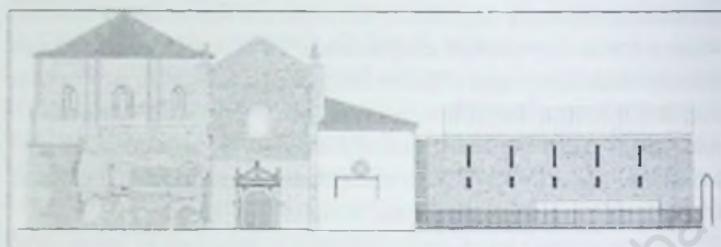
Proyecto. Alzado (José Ramón Duralde).
